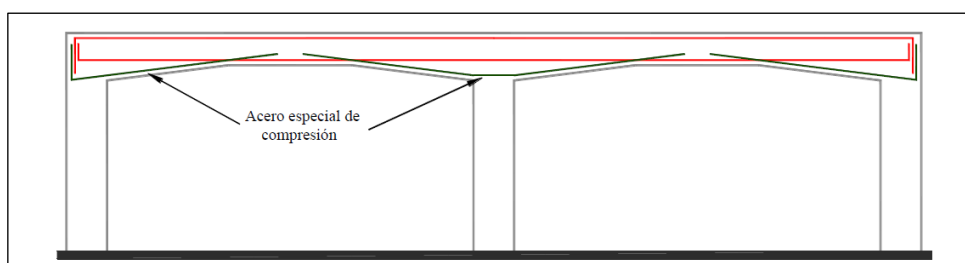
Arreglo del refuerzo inclinado propuesto por Mörsch.
